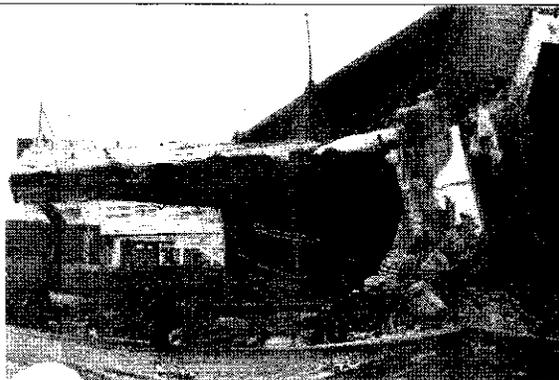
Colapso parcial de la cubierta del costado sur de la bodega.
